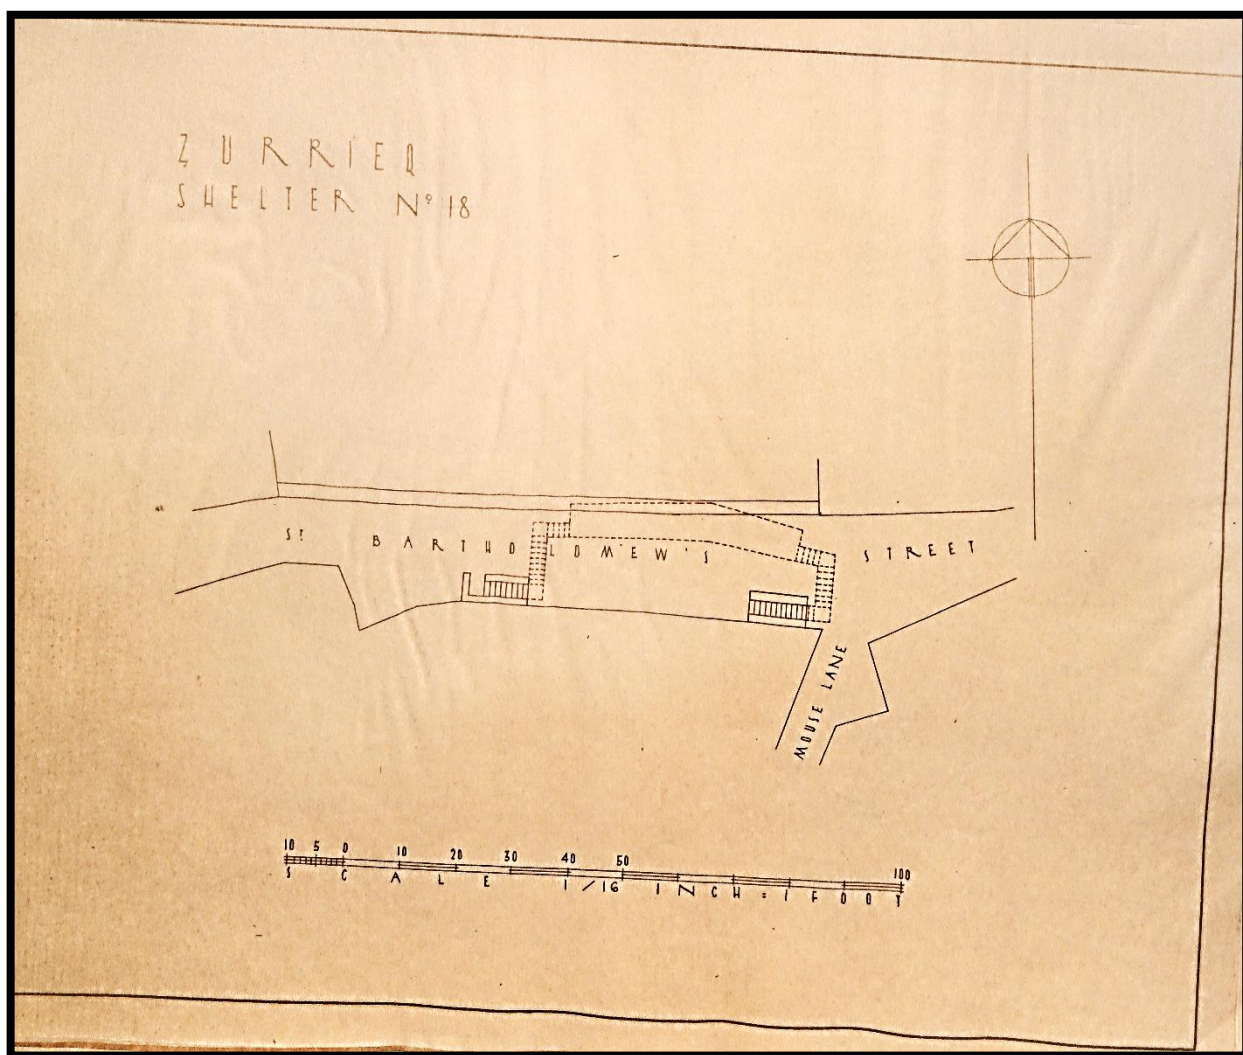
Planta do Abrigo nº18 "St. Bartholomew's Steet"
